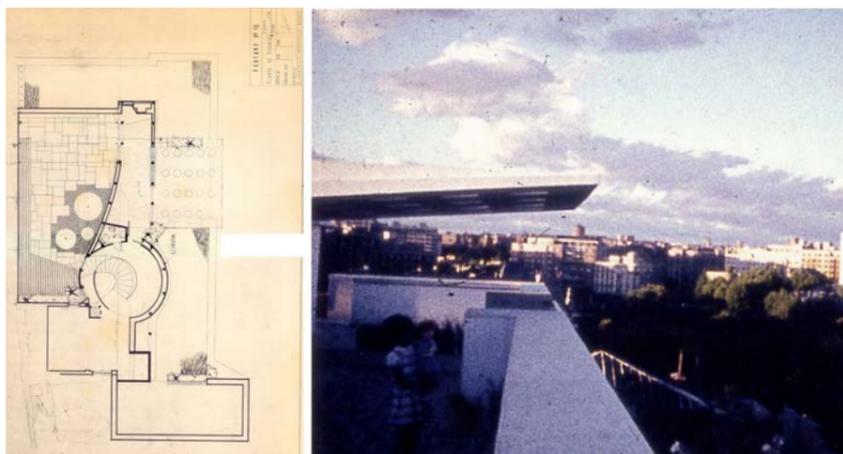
Fortuny 14, planta de terrazas y fotografía hacia la Castellana. Fuente: Servicio Histórico, Fundación Arquitectura COAM: MGD/P024-18, MGD/F047.
